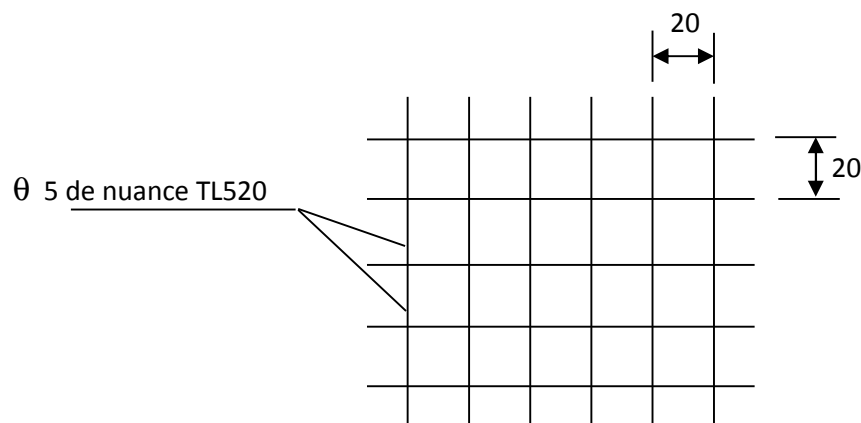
Ferrailage de la dalle de compression avec un Treillis soudé 20x20cm
